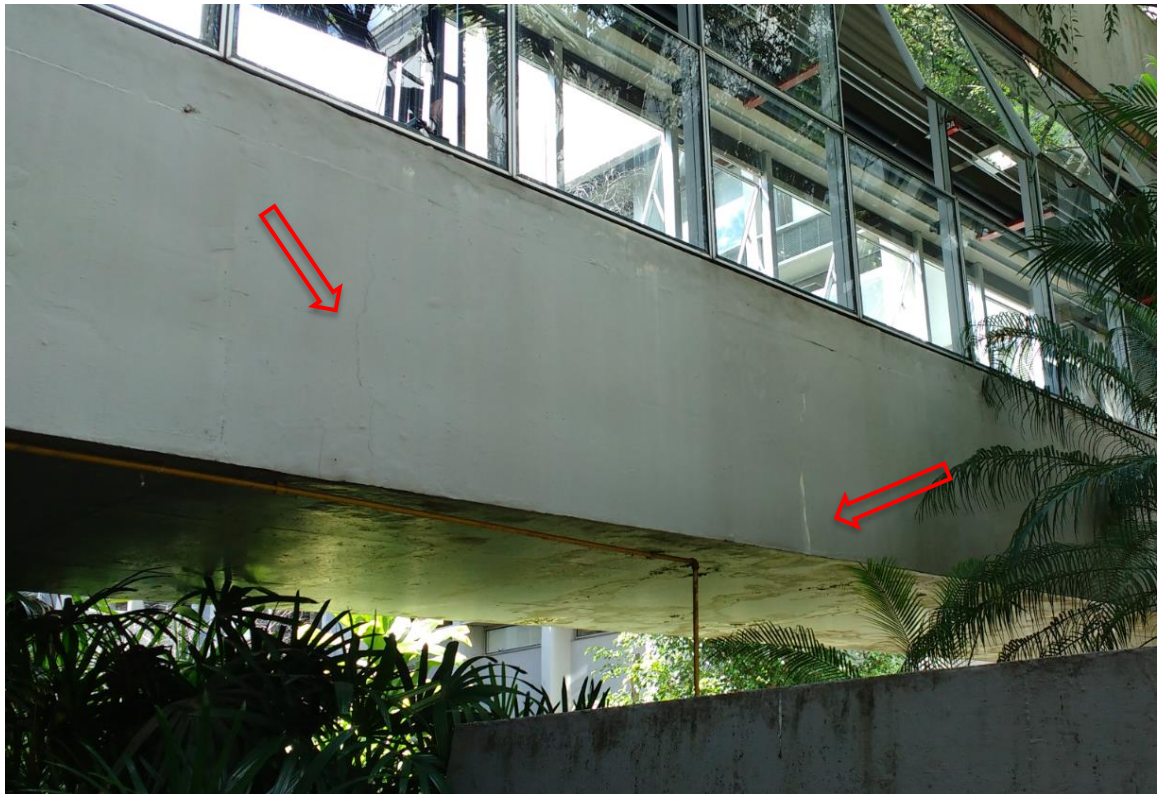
fissuras e mancha de carbonatação na face externa das vigas.
